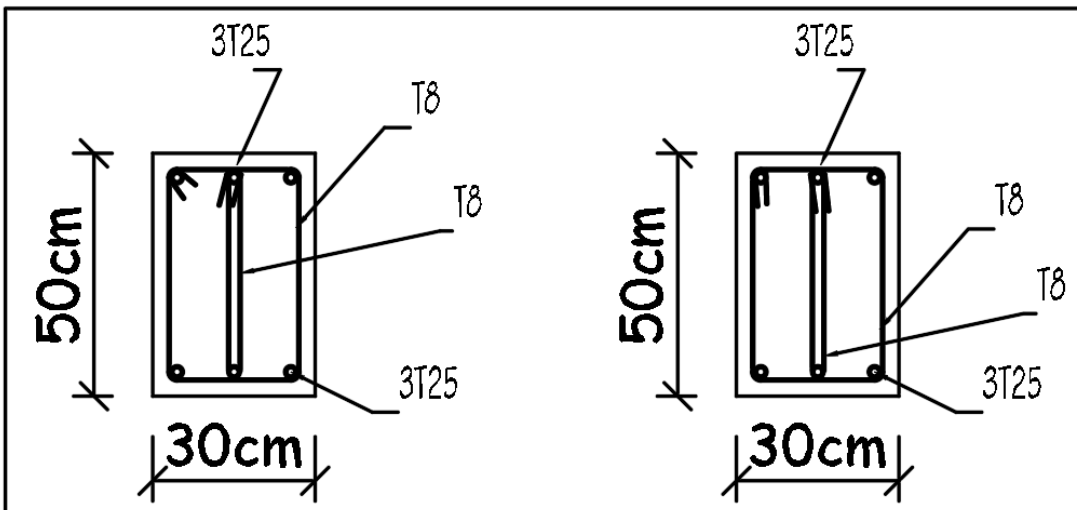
Ferrailages des poutres secondaires extérieures.
